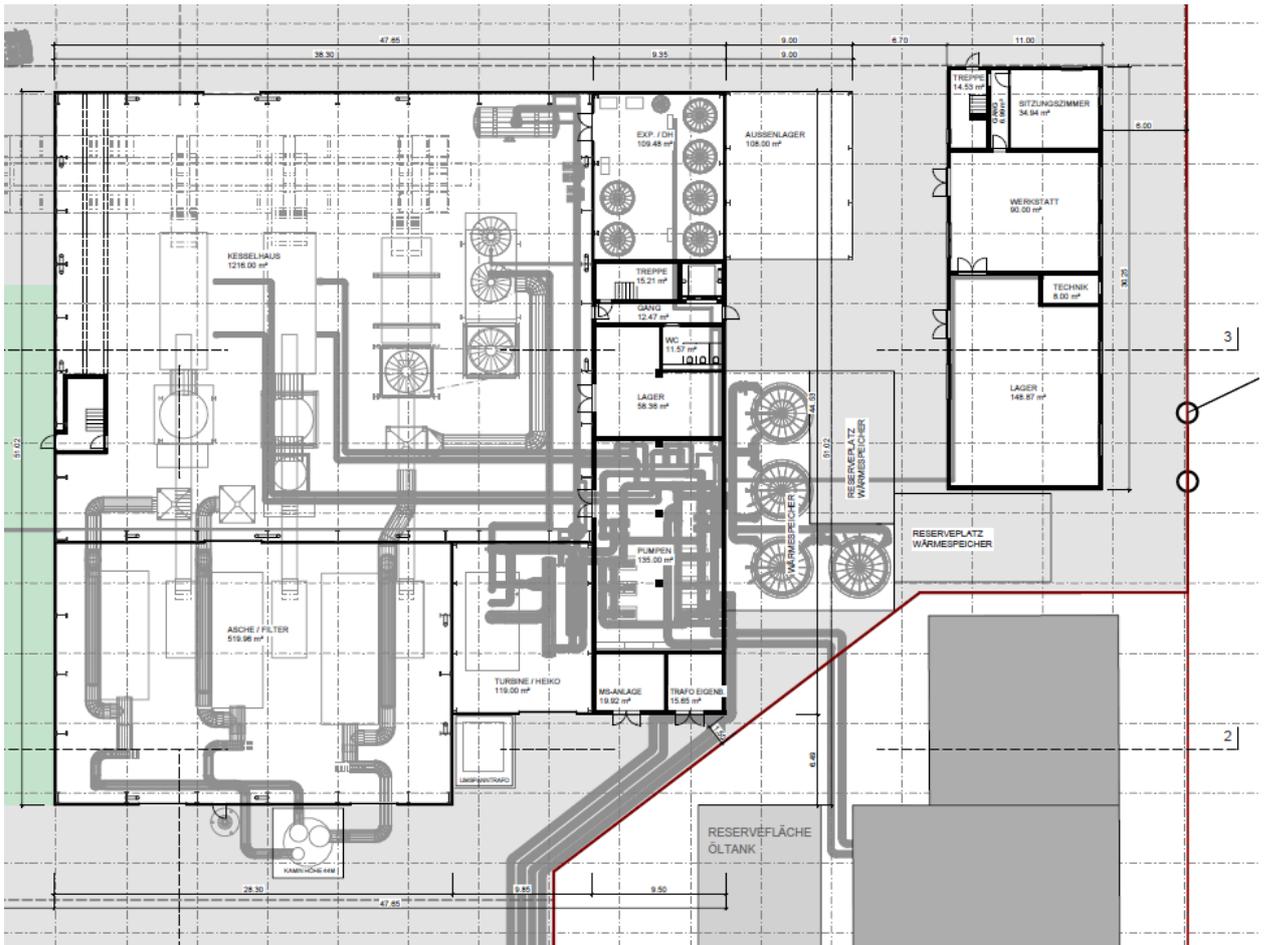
Grundriss Kesselhaus/Asche/Filter/Technik mit Wärmespeicher und abgesetzten Dienstgebäude/Werkstatt.
